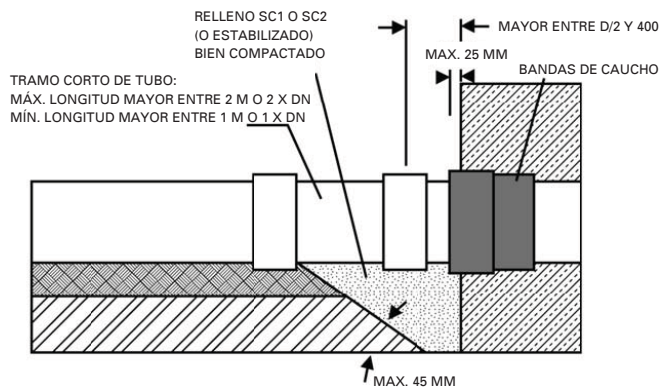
Conexión Alternativa- Bandas de caucho empotradas en concreto
